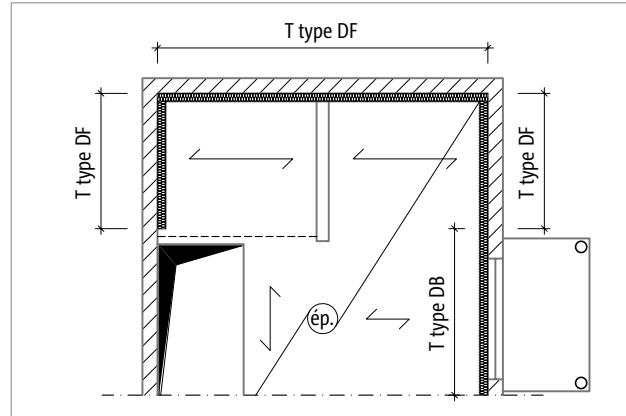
Schöck Rutherma® T type DF : utilisation entre la dalle et la façade
